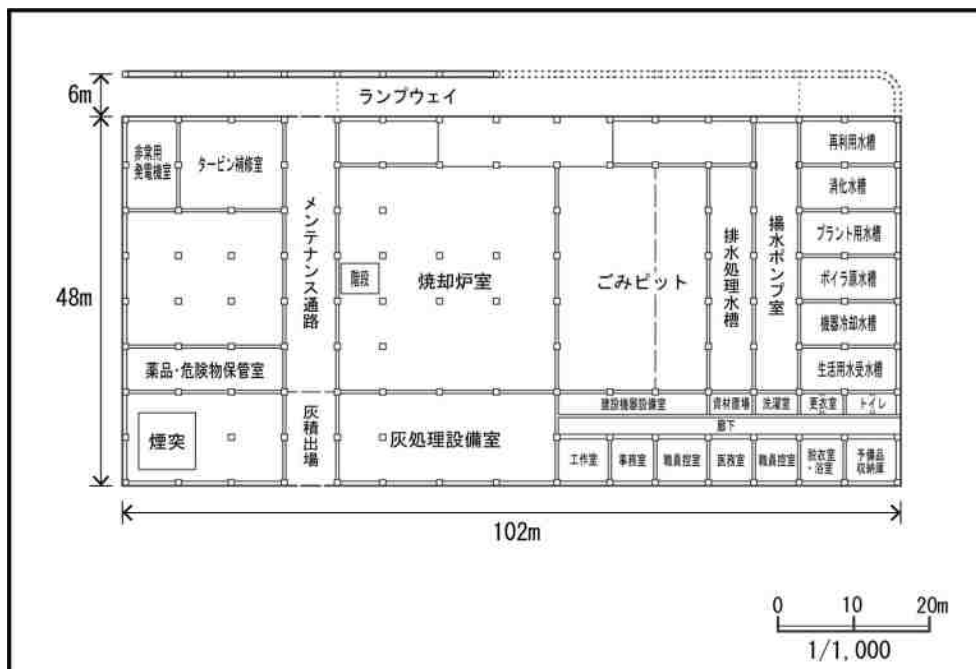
(2) 新施設の平面図（新焼却処理施設 1 階）
